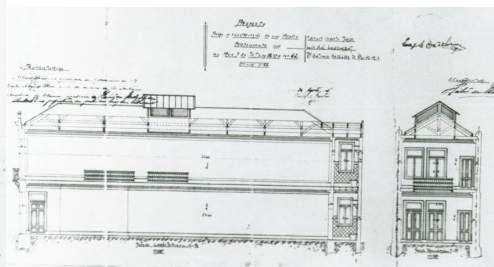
Corte Transversal e Longitudinal – Alberto Flores. Fonte: Arquivo Nacional.
